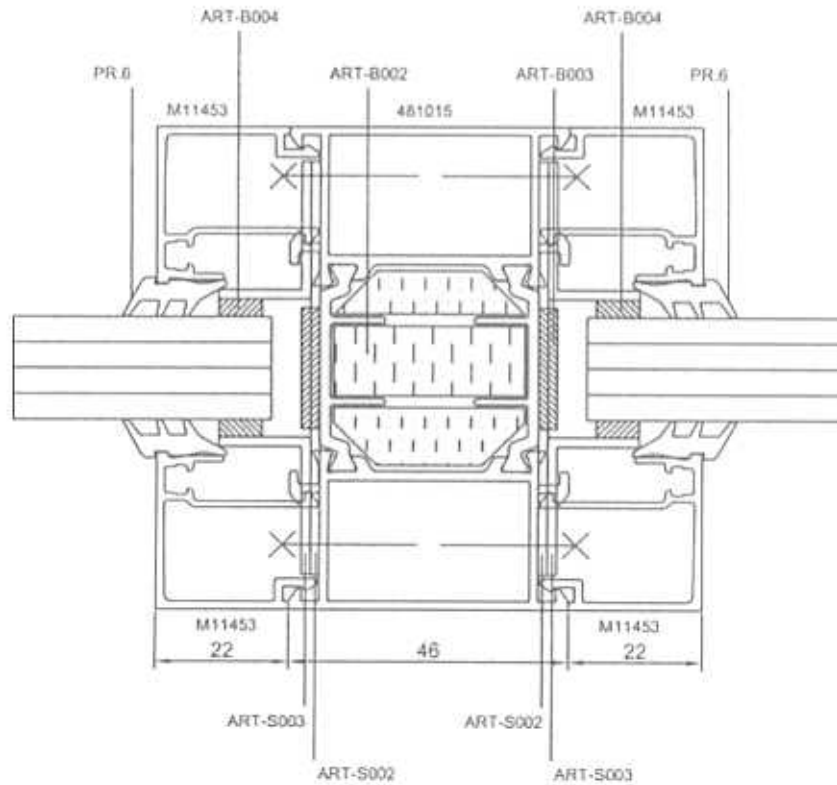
Przekrój 6-6 segmentu ścian wewnętrznych odmian ALUFIRE EI 15 i ALUFIRE EI 30 (przekrój przez element poziomy górny ramy)
